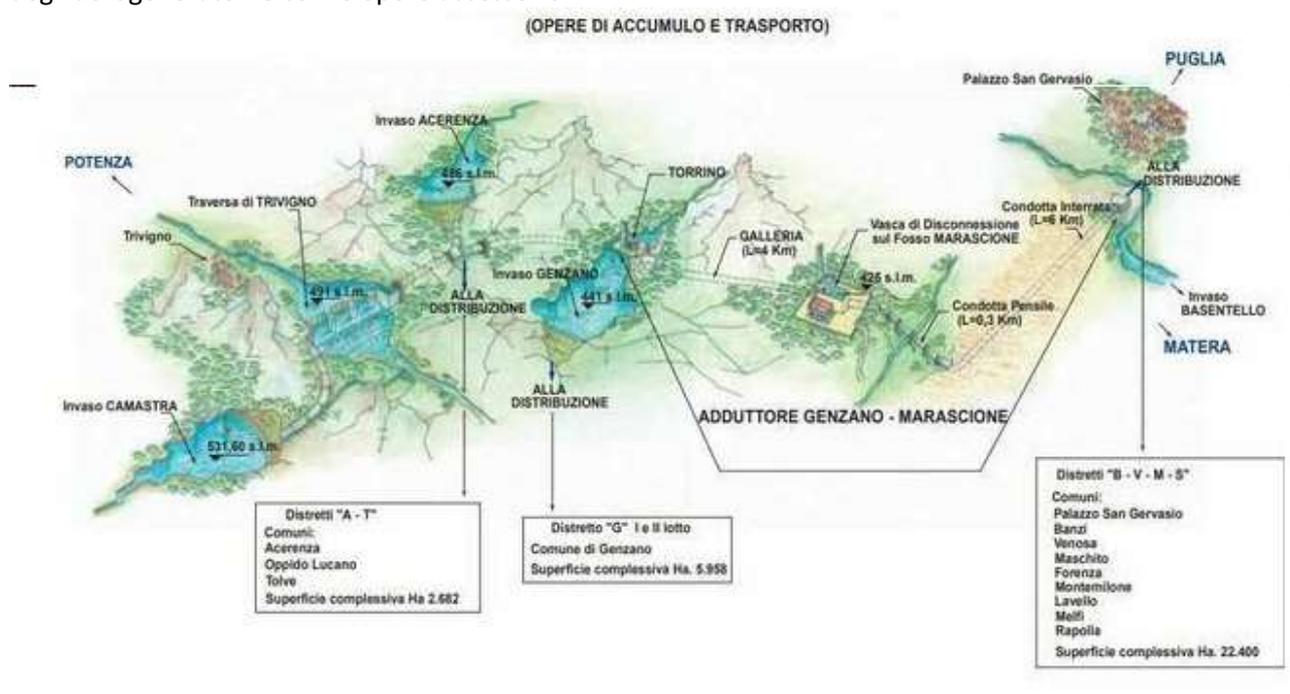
Layout del progetto - (Stralcio Tav. A.16.b.1)
